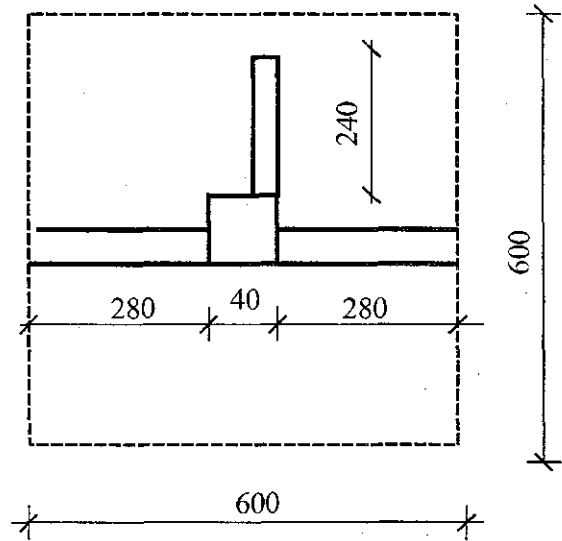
Схема расположения перегородок на участке перекрытия 6x6 м
